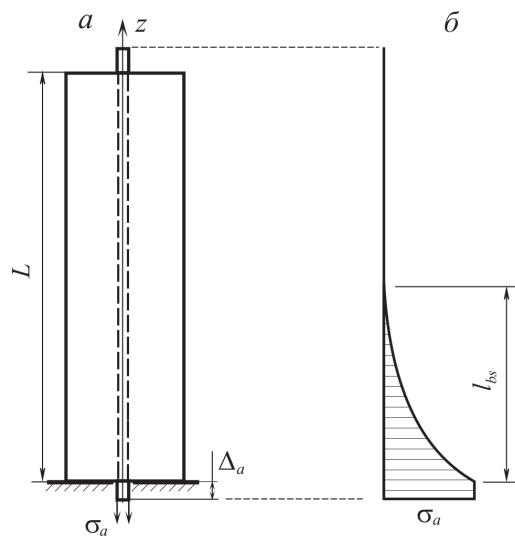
Схема вытягивания арматуры из бетона (а); эпюра нормальных напряжений в арматурном стержне (б)
